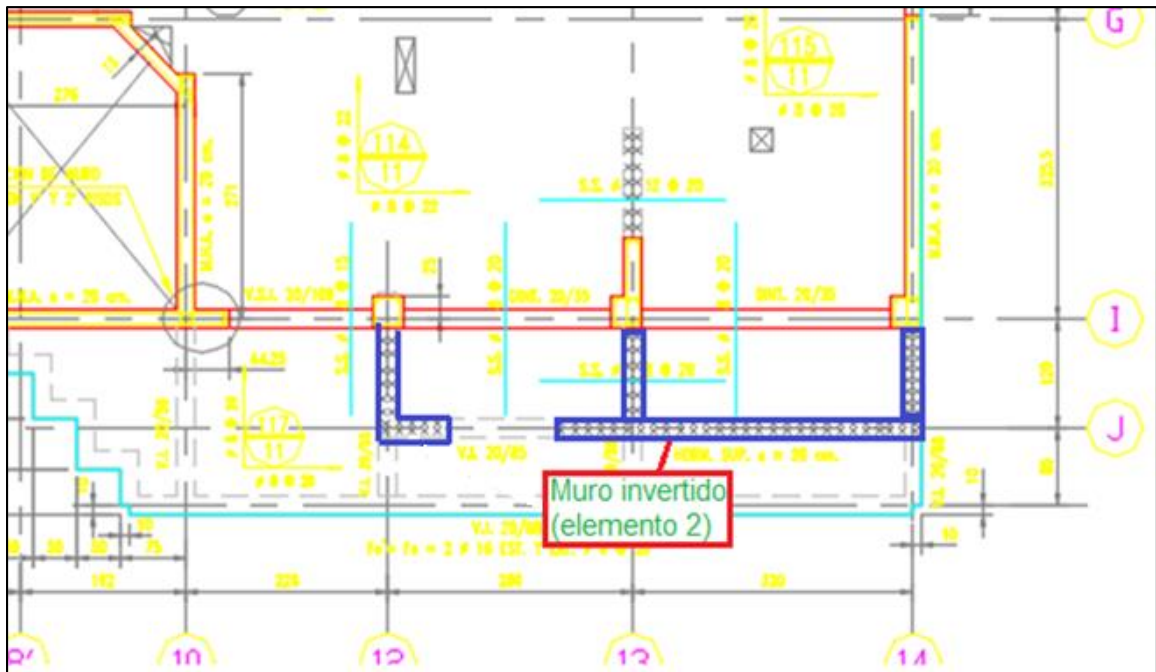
Elemento fuera del plano vertical, vista en planta piso 1 del edificio T15 (elemento 2)
